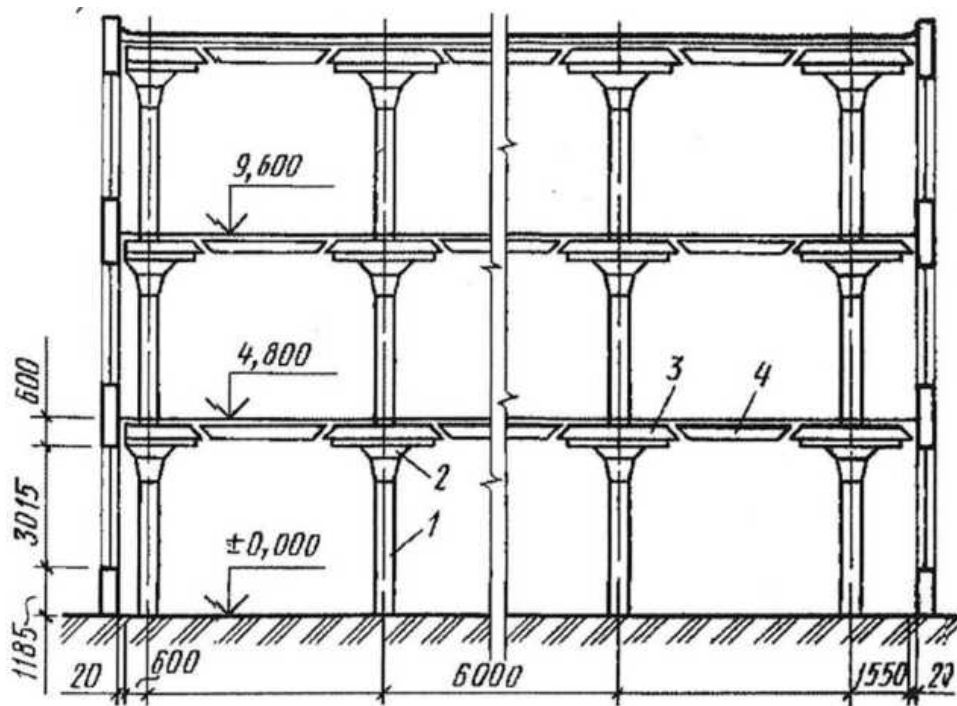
Багатоповерхова збірна будівля з безбалковими перекриттями:
